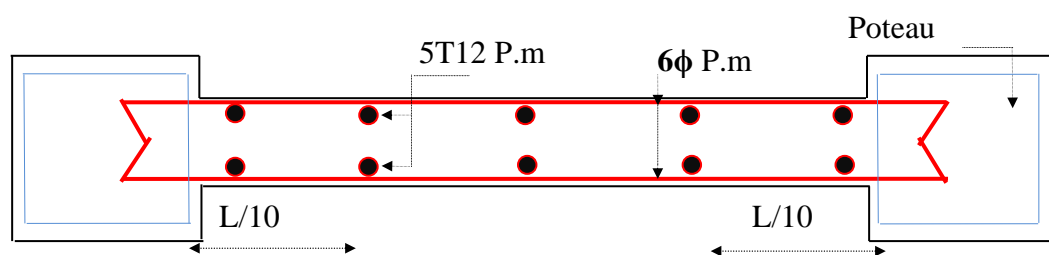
Disposition des armatures verticales dans les voiles.
